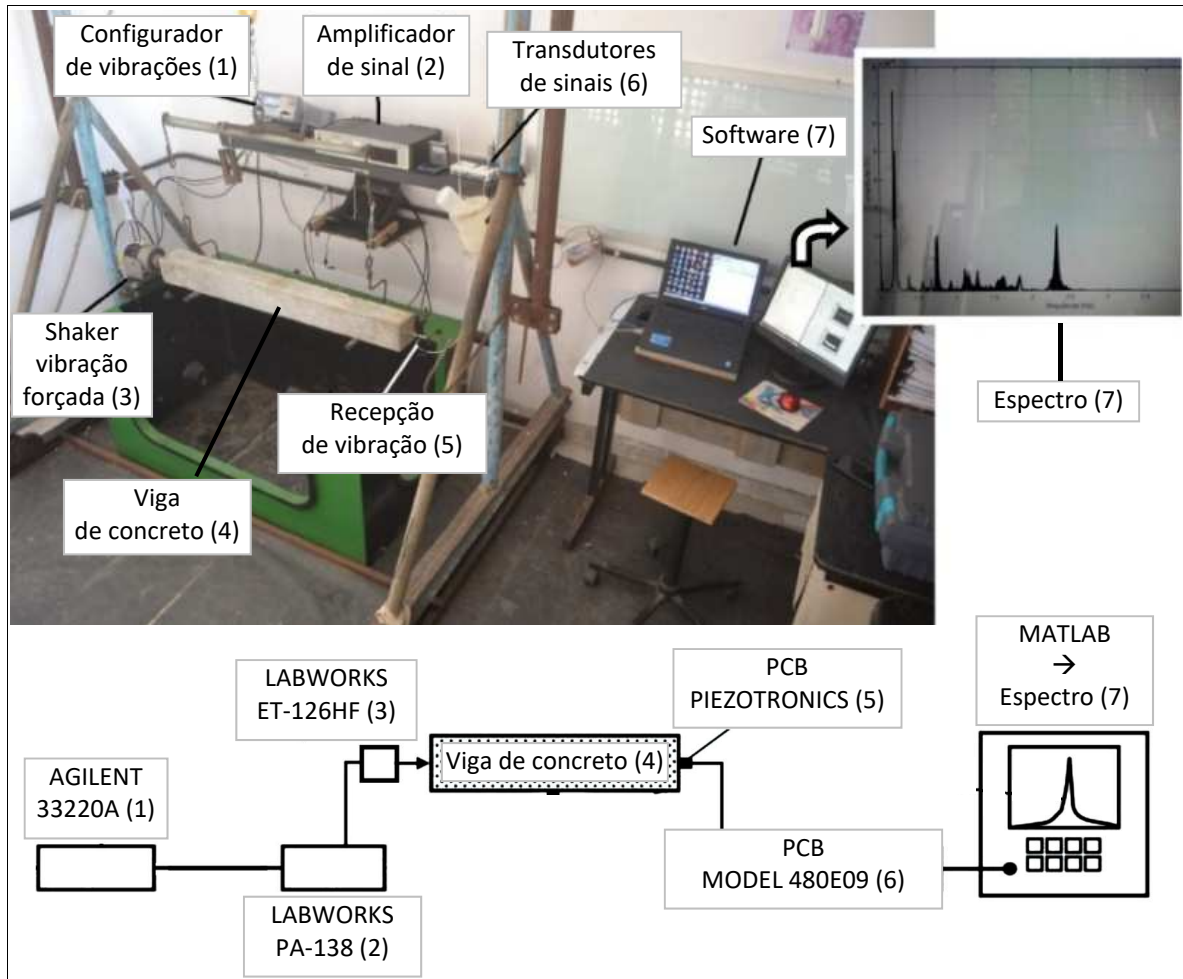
Esquema do ensaio de ressonância longitudinal
